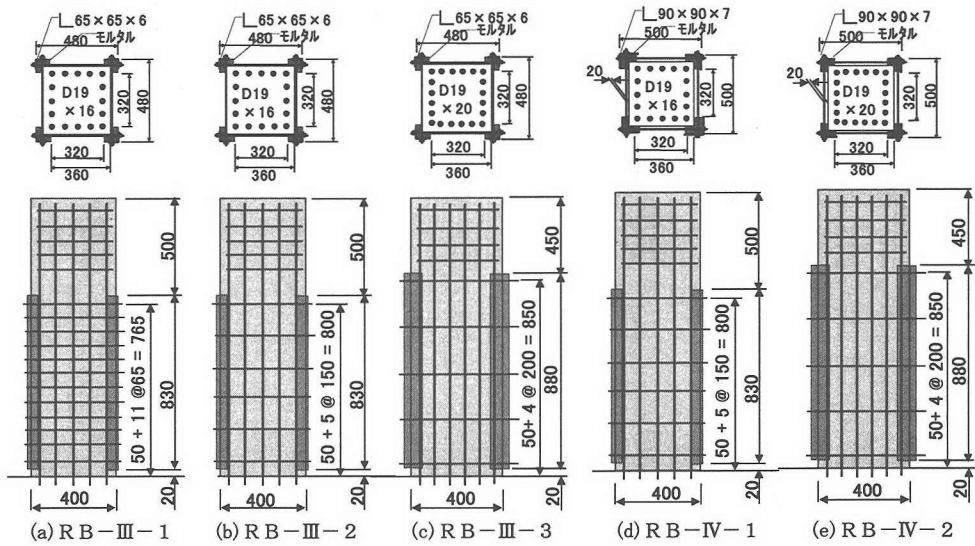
耐震補強試験体断面図および側面図, R-C試験体断面図
